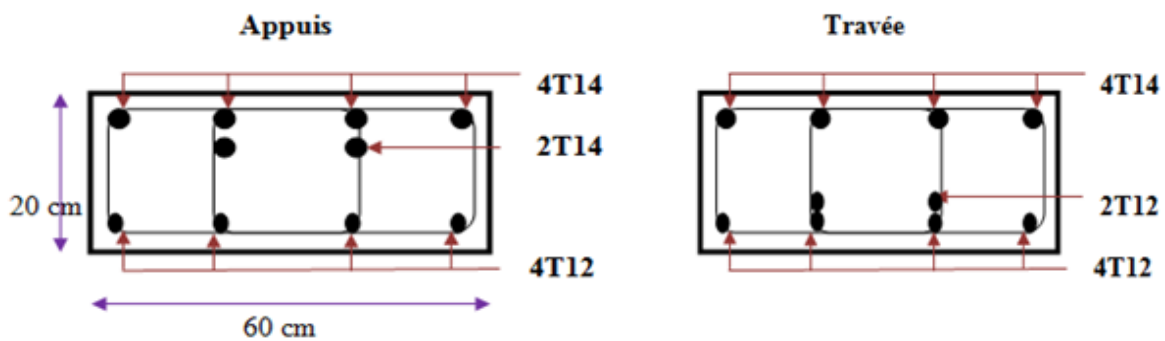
Schémas de ferrailage des poutres noyées (60×20)
